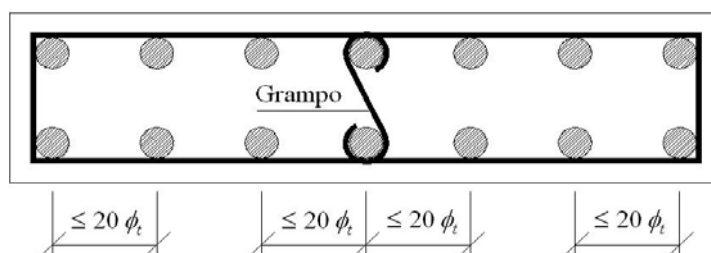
Proteção contra flambagem das barras longitudinais
